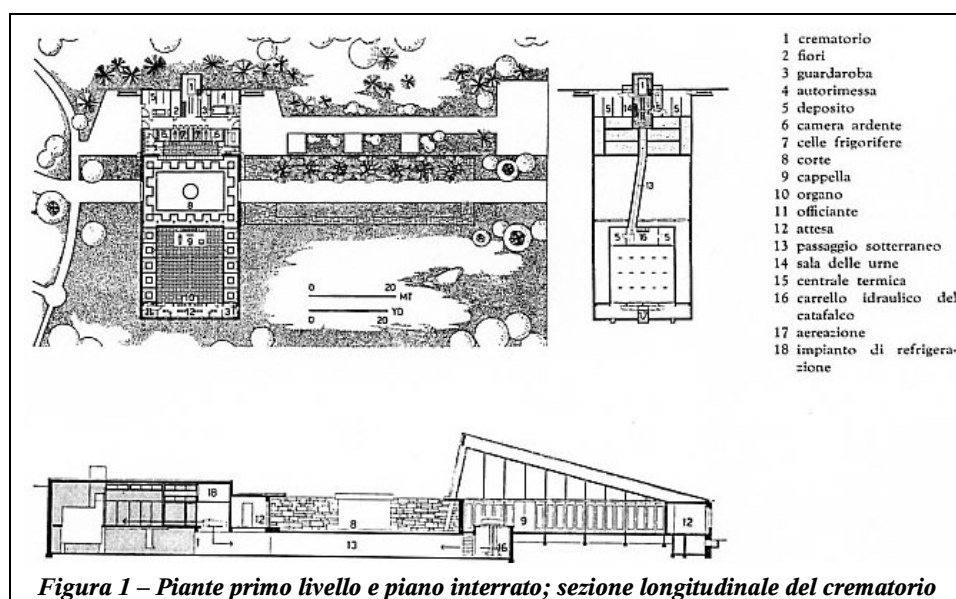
Pianta primo livello e piano interrato; sezione longitudinale del crematorio
